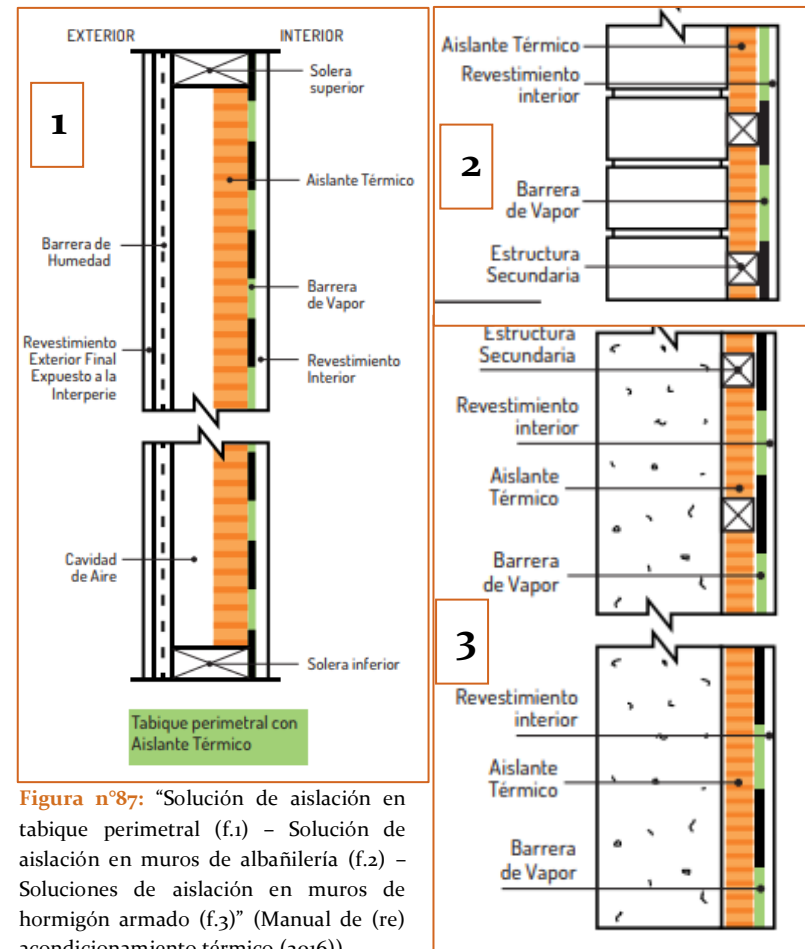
“Solución de aislamiento en tabique perimetral (f.1) – Solución de aislamiento en muros de albañilería (f.2) – Soluciones de aislamiento en muros de hormigón armado (f.3)” (Manual de (re) acondicionamiento térmico (2016)).
